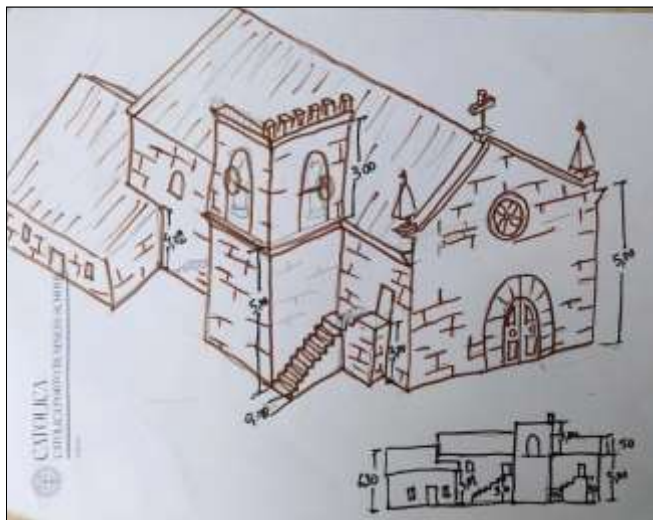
Esquema ou esboço em projeção ortogonal, realizado para o levantamento da igreja de Vila Marim.
